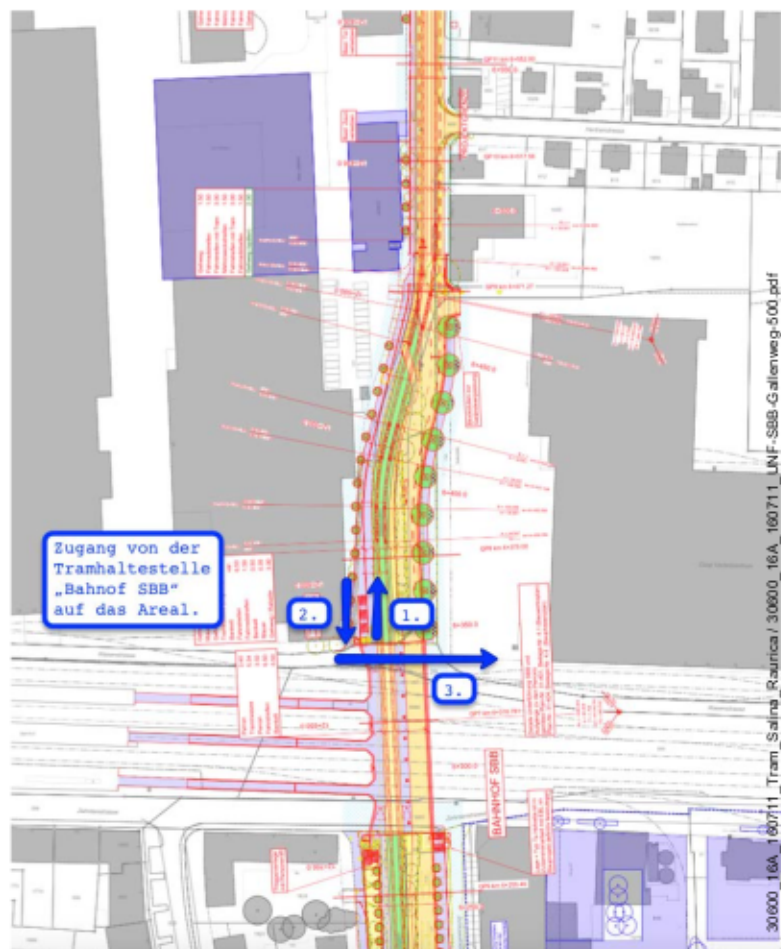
Ausschnitt Vorprojekt Tramverlängerung Salina Raurica Variante „à Niveau“ entlang dem Gallenweg mit der Tramhaltestelle Bahnhof SBB (Quelle: Situationsplan Vorprojekt Trasse, Gleisbau vom 31.10.2014)
